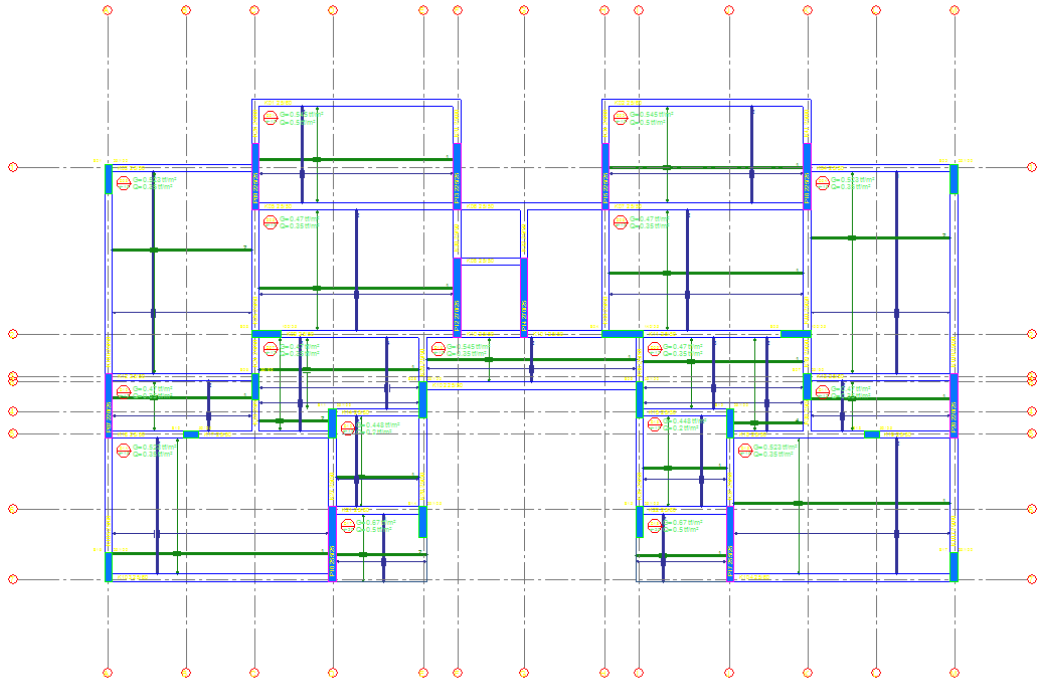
Bina kodu E için plak döşemeli haline ait kalıp planı
